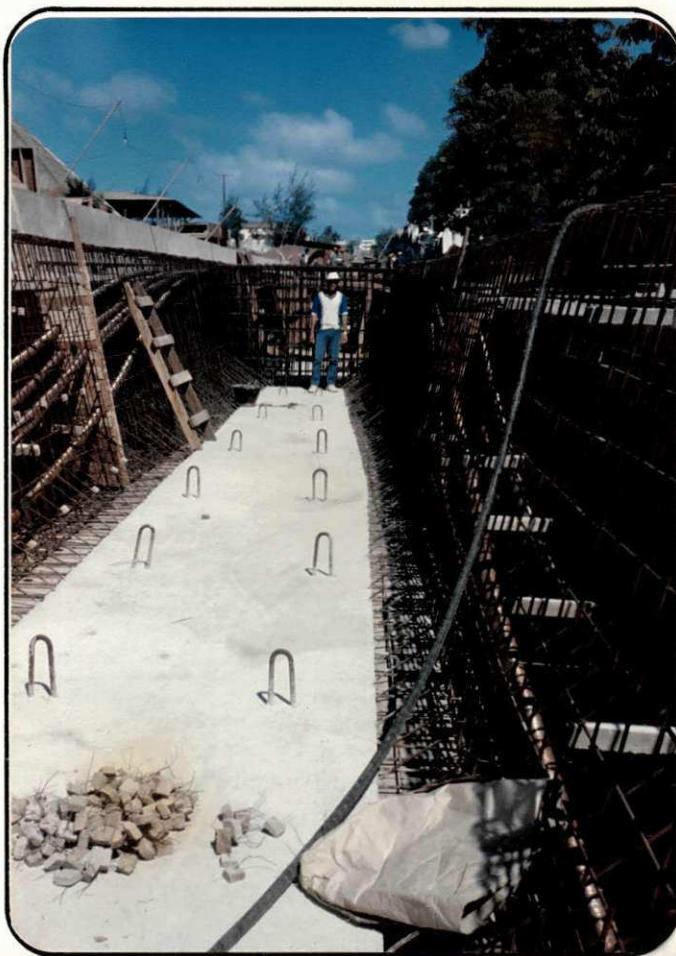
Vista da viga da pista direita com a parte inferior já concretada e detalhe das bainhas onde ficam os cabos de proteção.
